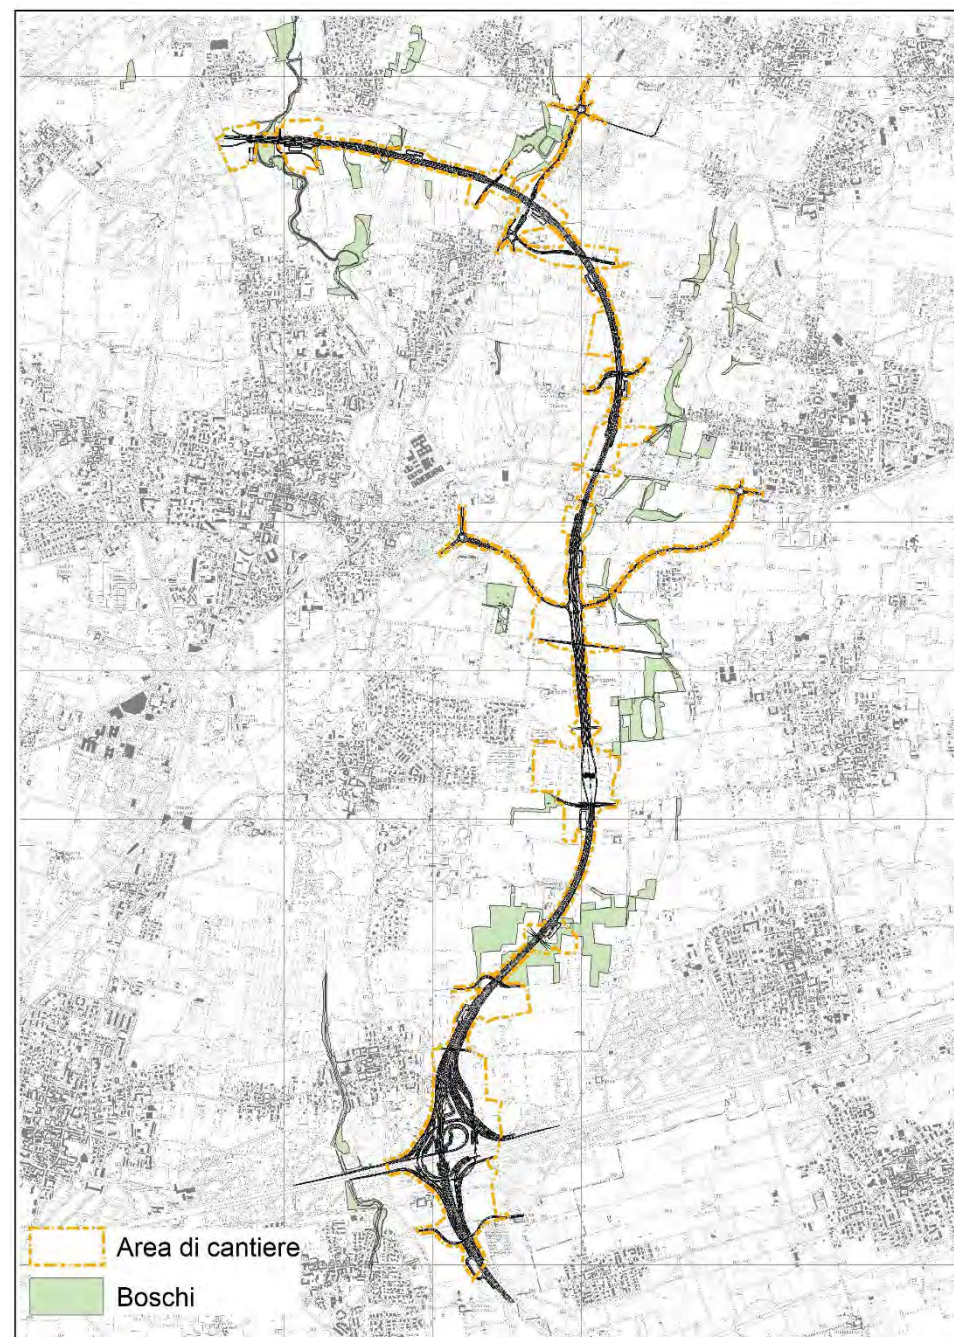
Localizzazione delle superfici forestali rispetto alle aree di cantiere
